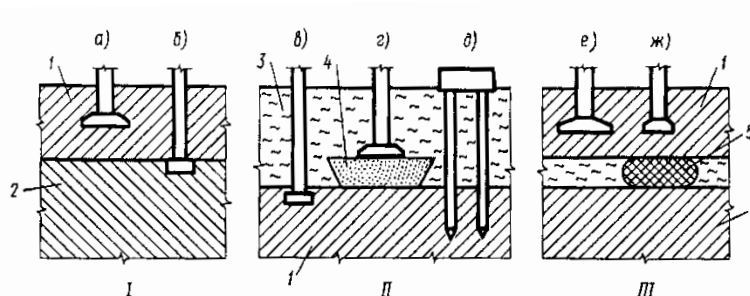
Схемы напластований грунтов с вариантами устройства фундаментов:
